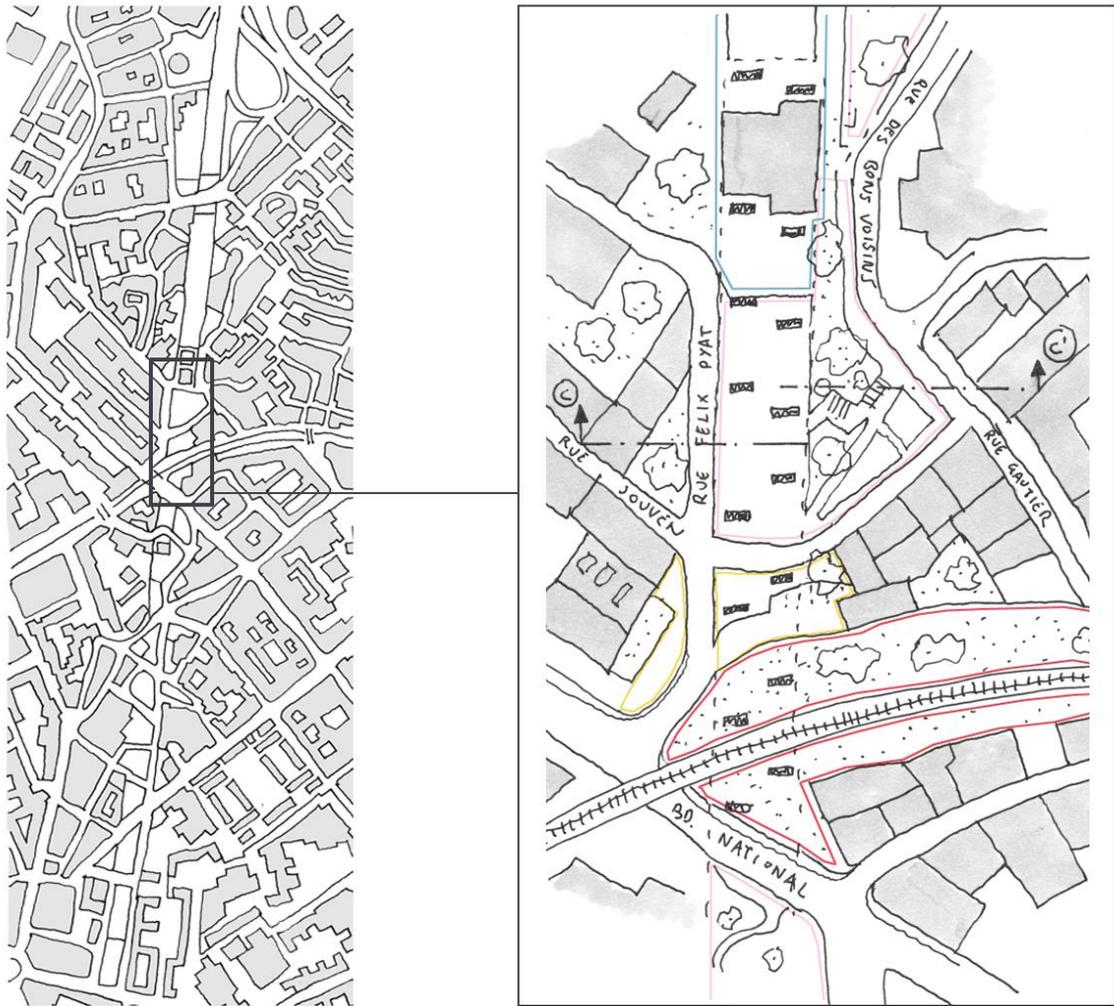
Plan et coupe au niveau de la Place Arzial (G. Salvia, 2018)
